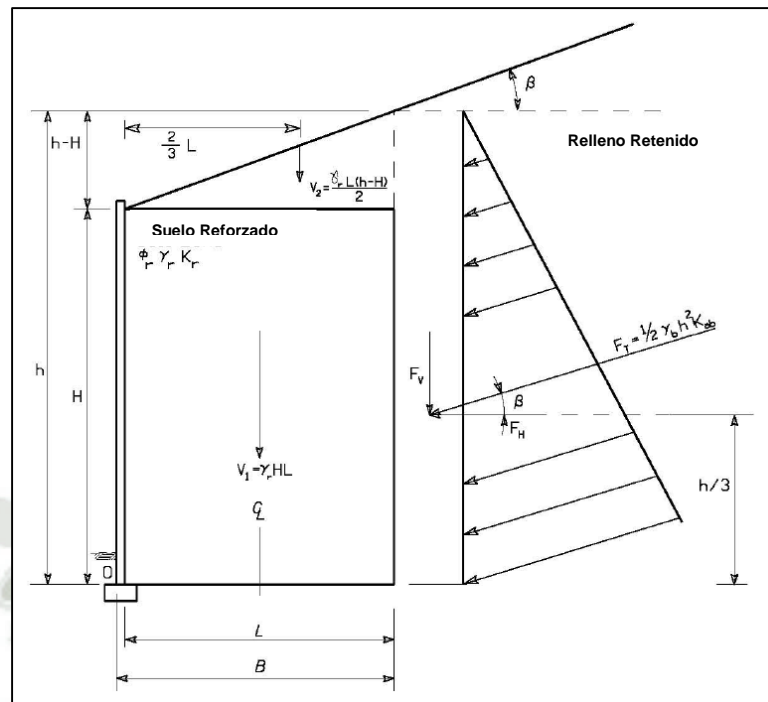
Fuerzas Actuantes en un Muro con Talud Inclinado Constante (FHWA-NHI-10-024, 2009)
